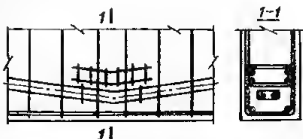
Усиление бетона дополнительным армированием в местах перегиба напрягаемой арматуры.
